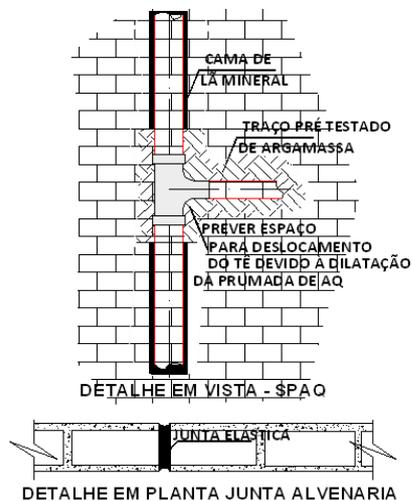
Detalhes de junta de expansão do SPAQ e dilatação da alvenaria.
